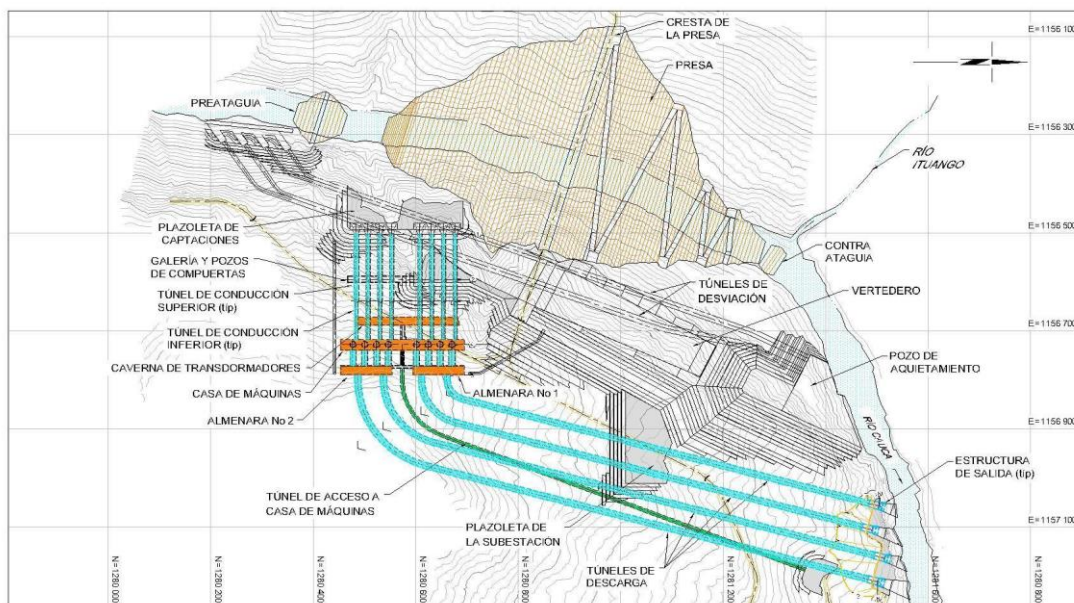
Esquema de las obras en planta del P. H. Ituango, Col.
